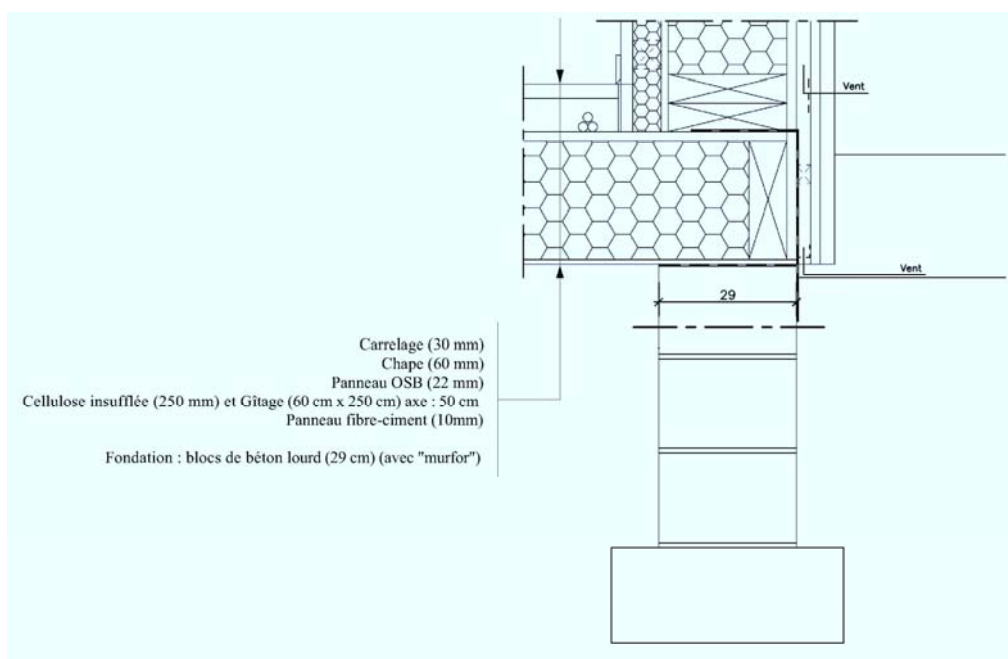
Détail et composition du plancher du rez-de-chaussée
